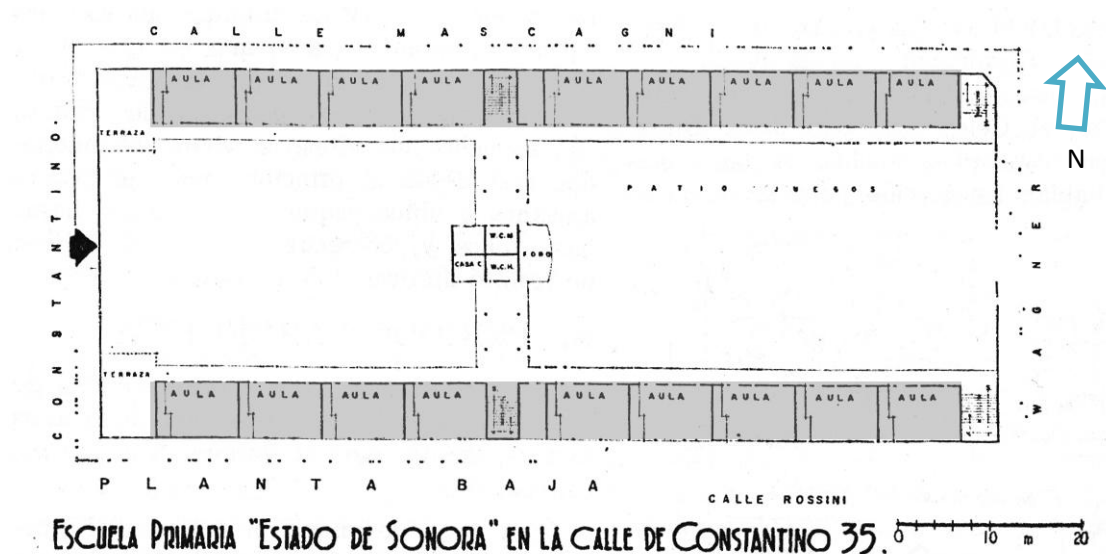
Planta arquitectónica del Centro Escolar 'Estado de Sonora' (García Ramos, 1970).
